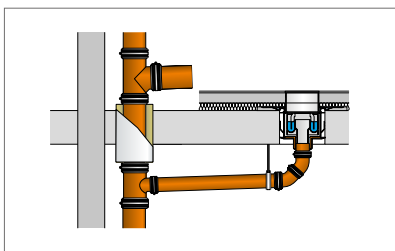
Viega Advantix R 120 Bodenablauf und Rohrdurchführung – nicht brennbare Entwässerungsleitungen
